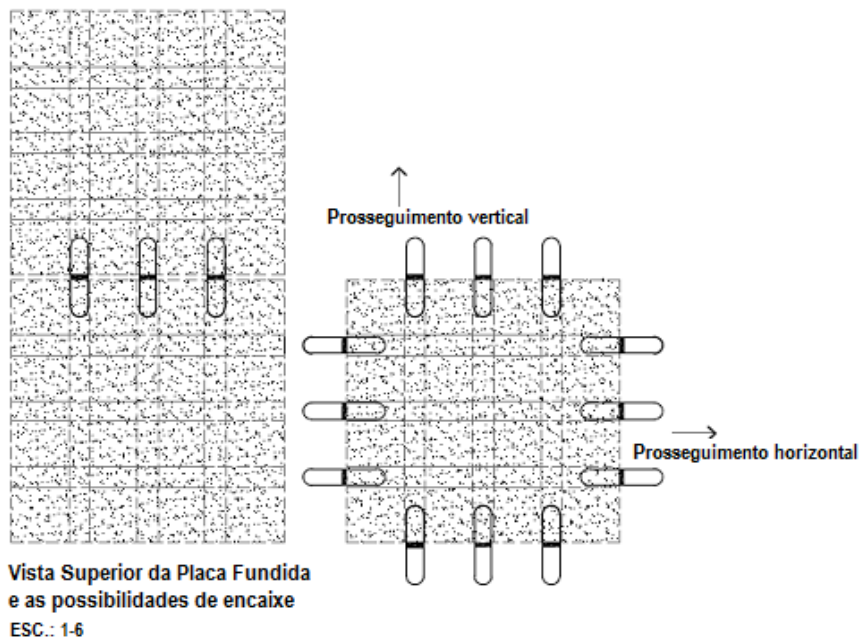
Vista do encaixe entre as placas para construção de painel.
